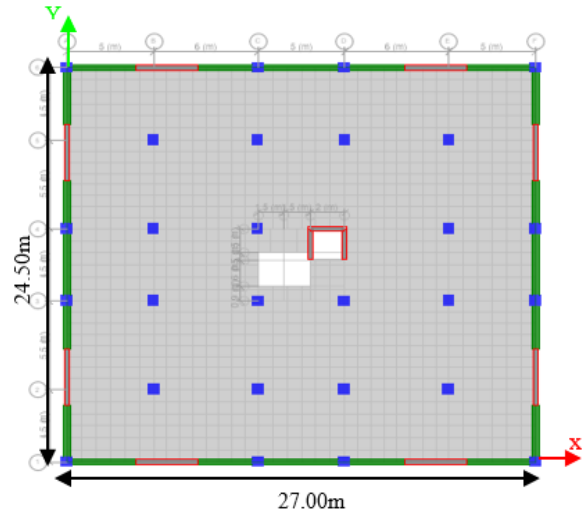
Planta de las edificaciones con sistema dual. ETABS 2016 [14]
